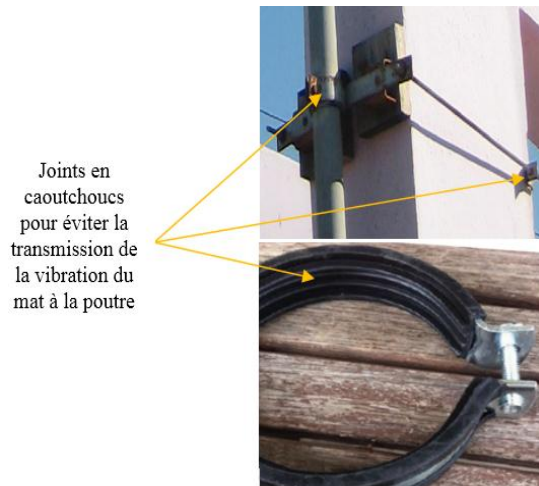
Fixation du mat à la poutre avec système anti-vibration
